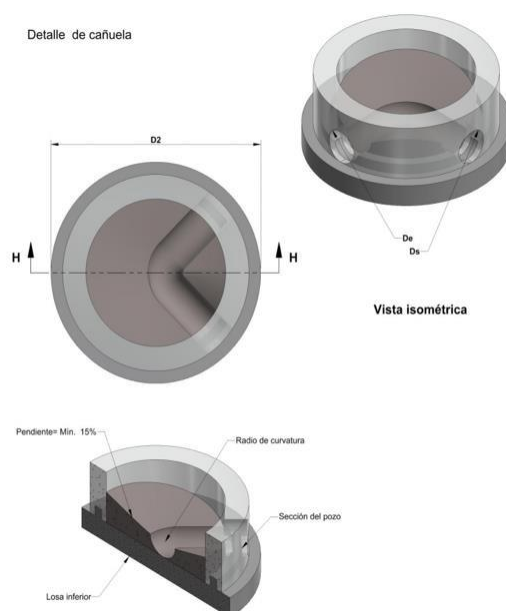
Detalle de cañuela. Fuente. EPM, 2017
